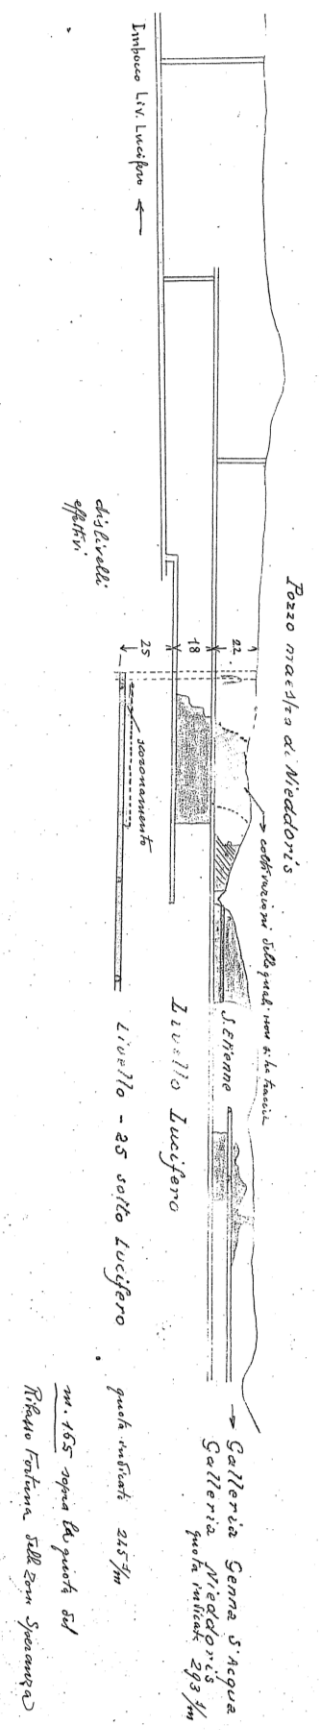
Sezione Longitudinale "Filone Nieddoris". Scala 1:2000.
